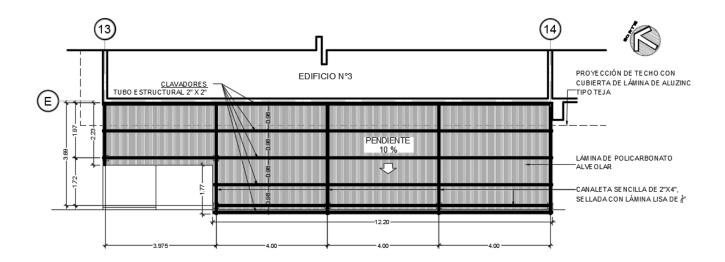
Planta de techo en Atención al Público, Edificio N°3
